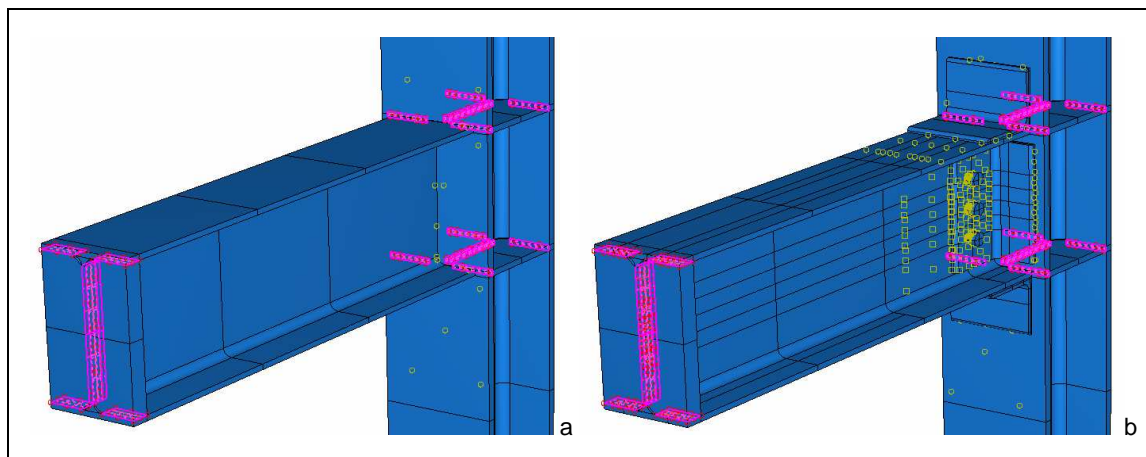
Ligações rígidas dos elementos aos reforços transversais, (a) WW-S1, (b) TSW-S1.
